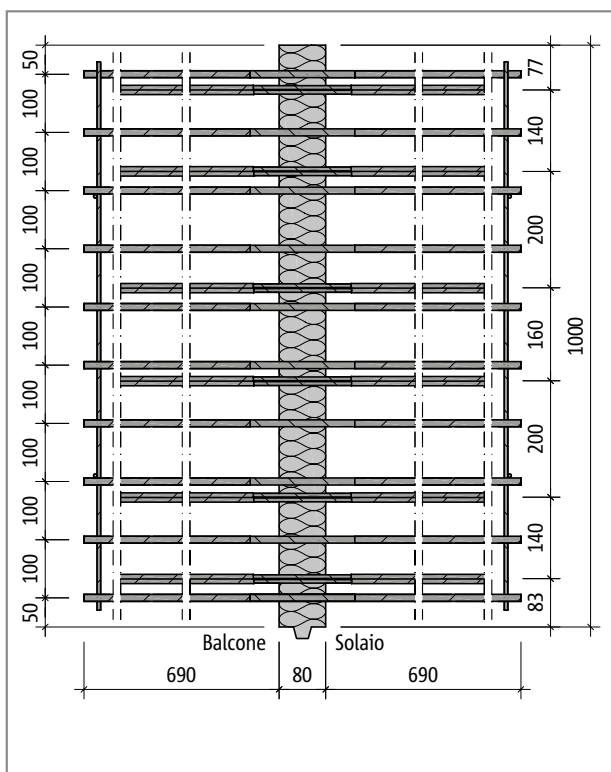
Schöck Isokorb® tipo D40M, pianta del prodotto
